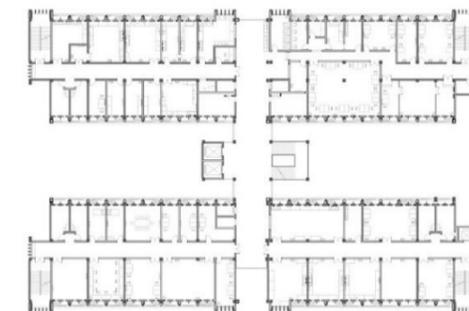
Troisième plan d'étage du bâtiment de la technologie médicale, Source : Archdaily
